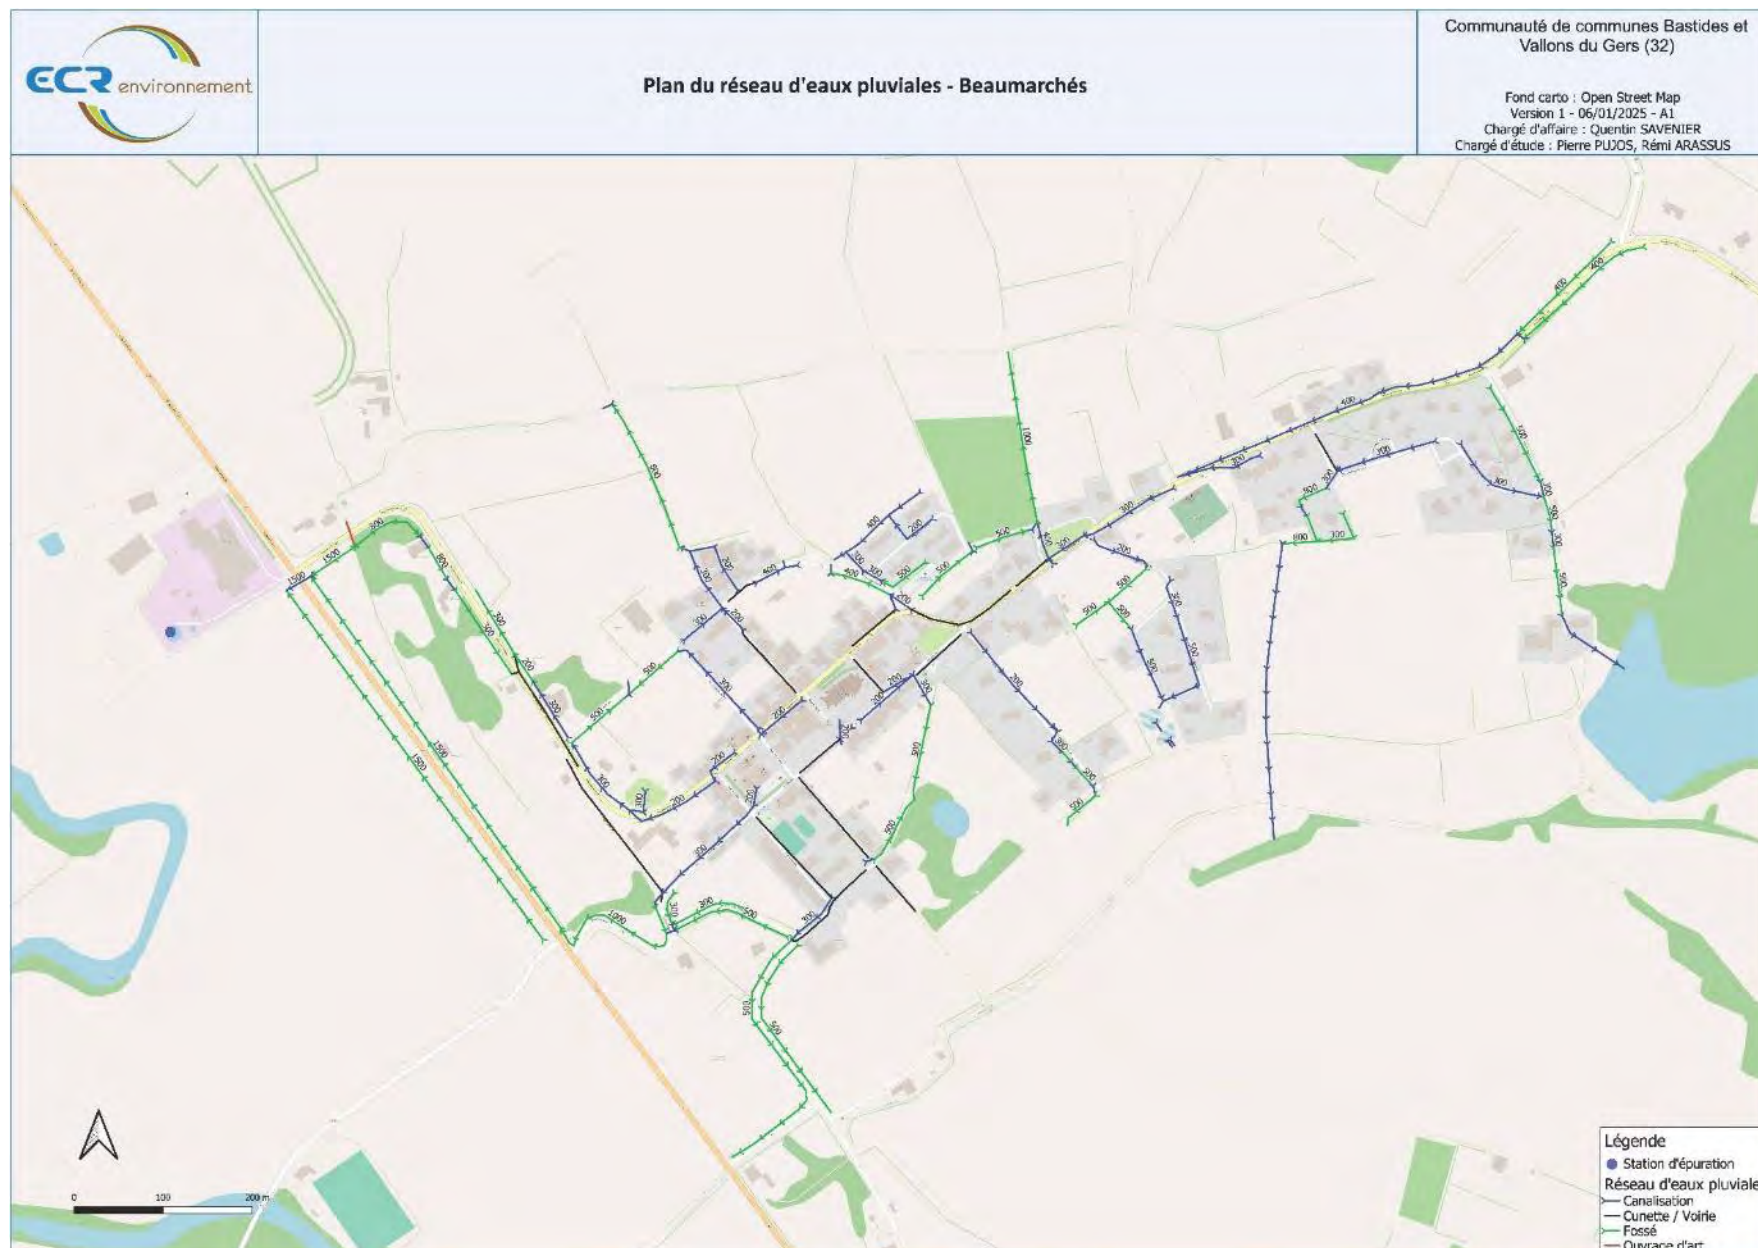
Plan du réseau d'eaux pluviales de Beaumarchés, source ECR
